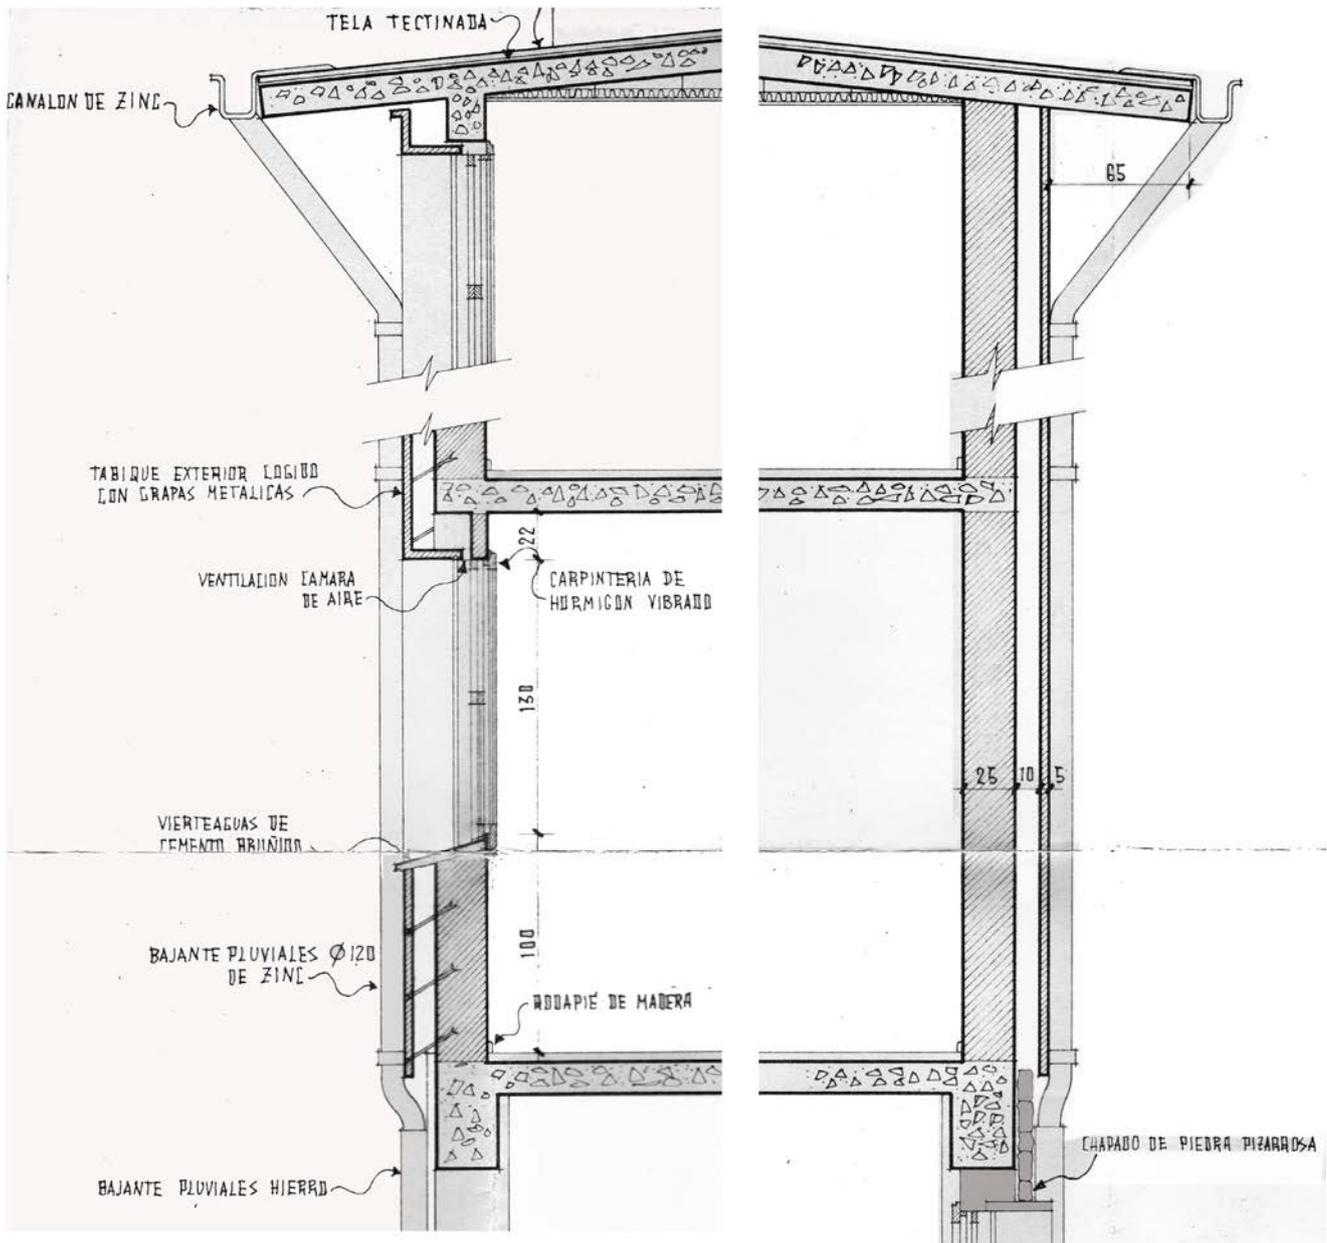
Pormenor del Plano N° 25. Sección Transversal Tipo. Escala 1:20. Abril 1956. A la izquierda: Sección de la fachada a la Avenida de Coímbra y a la derecha: Fachada al patio de manzana.
